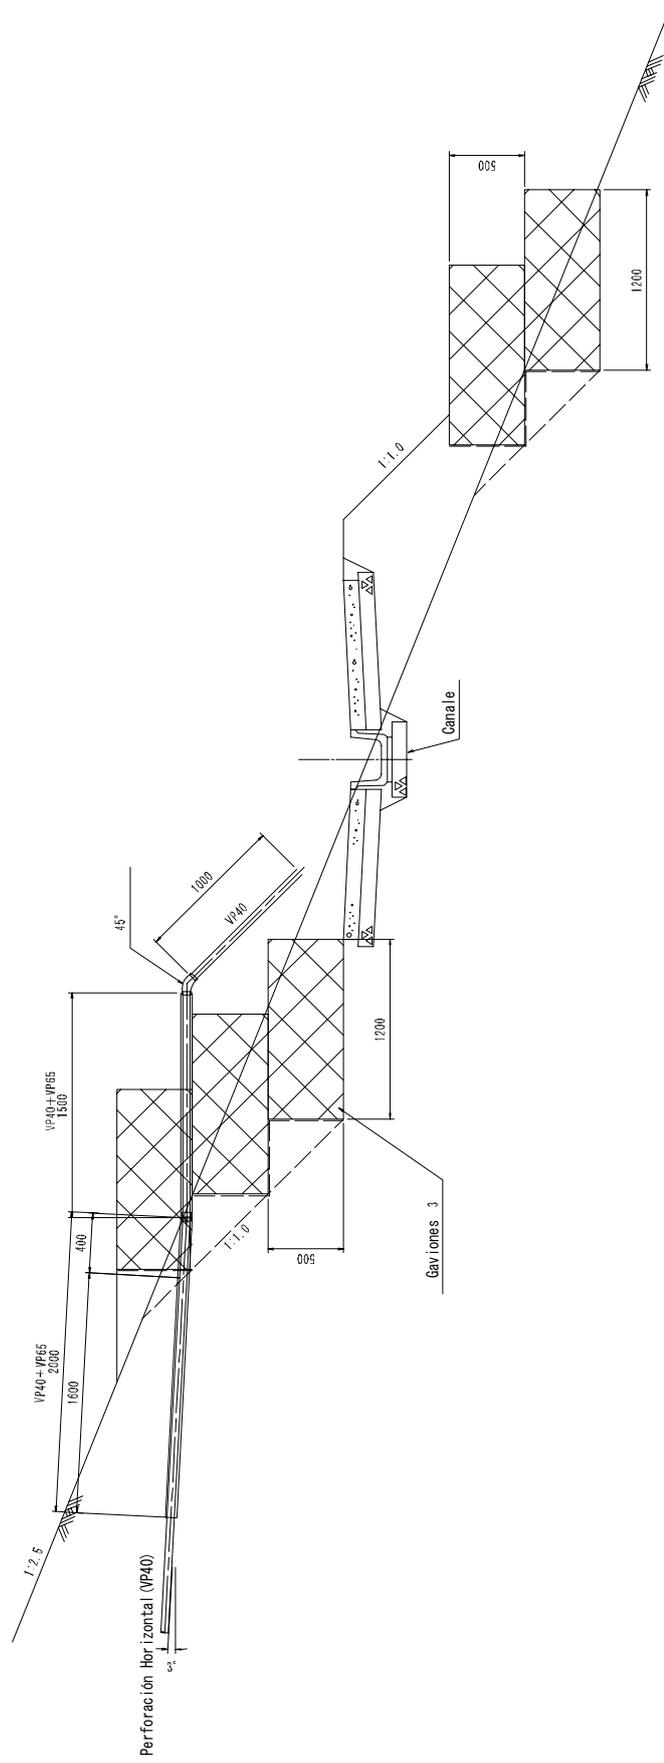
Plano detallado de tratamientos del extremo de flujo de perforaciones horizontales (El Berrinche)
